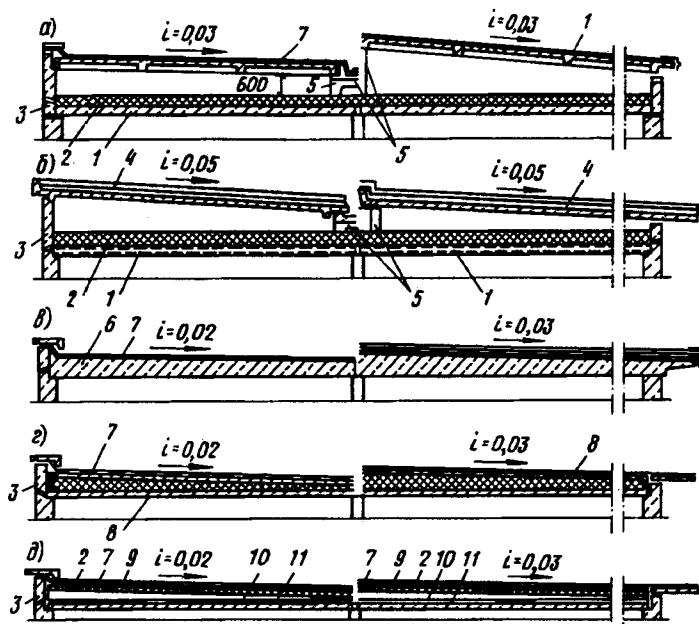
Принципиальные схемы конструкций бесчердачных железобетонных крыш
